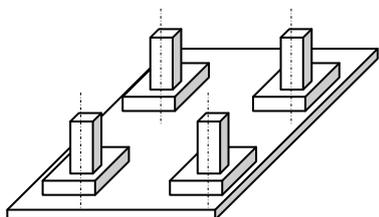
Плитный фундамент – аналог лап водоплавающих
